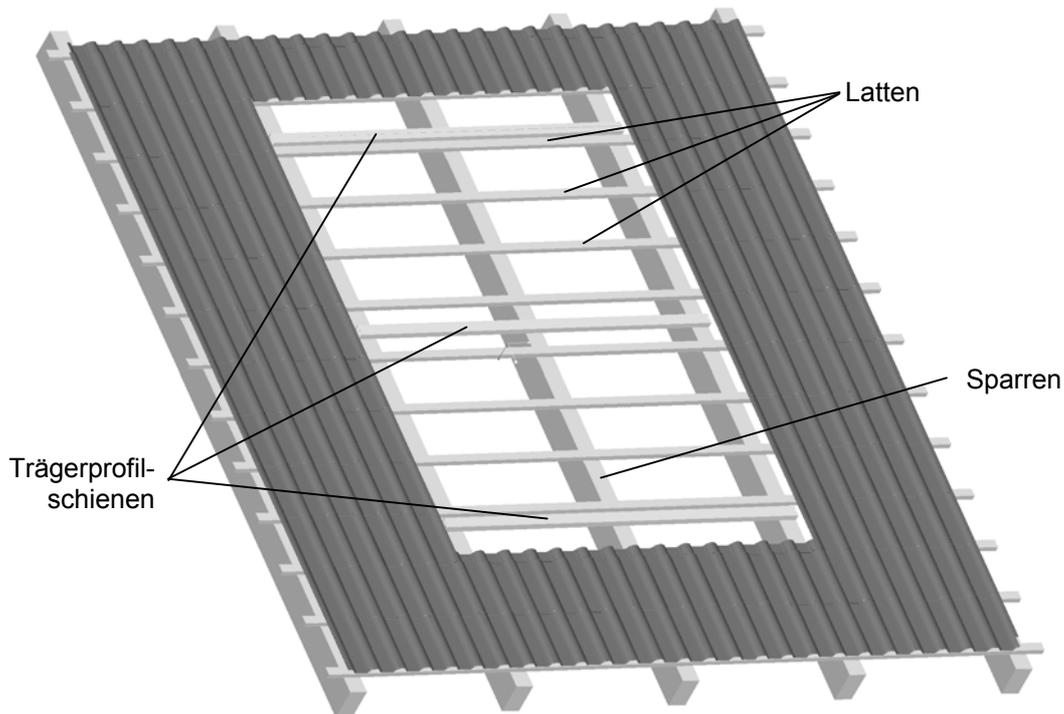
Abgedecktes Dach mit Trägerprofilschienen, Indach-Variante
